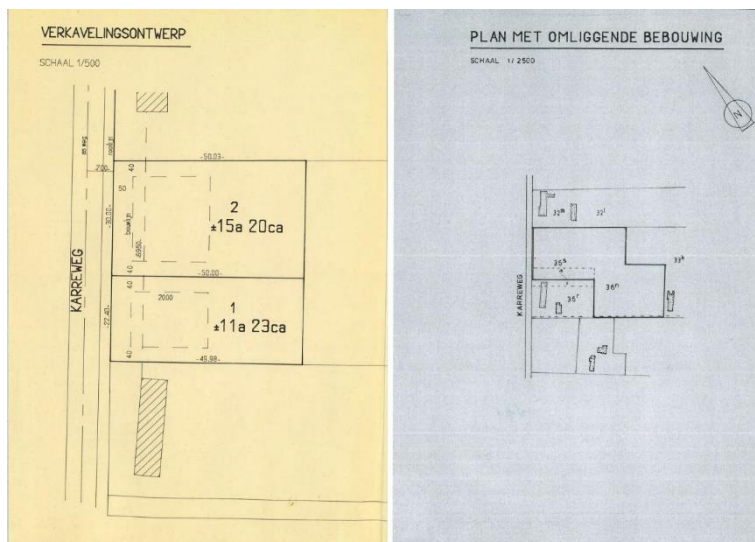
verkavelingsplan 2, bron: gemeente Kruisem
